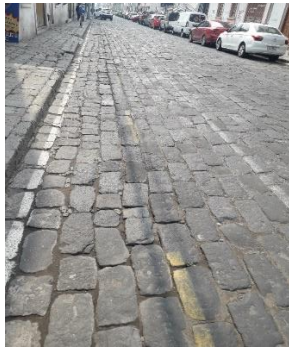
Calzada de piedra. Ciclovía Longitudinal
